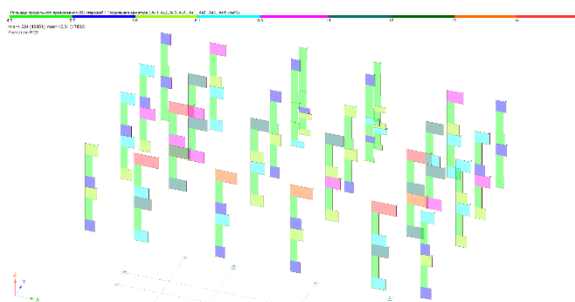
Расположение колонн и максимальная площадь армирование в колоннах на четвёртом и пятом этажах пяти этажного каркасного железобетонного здания без внутренних и наружных стен.
